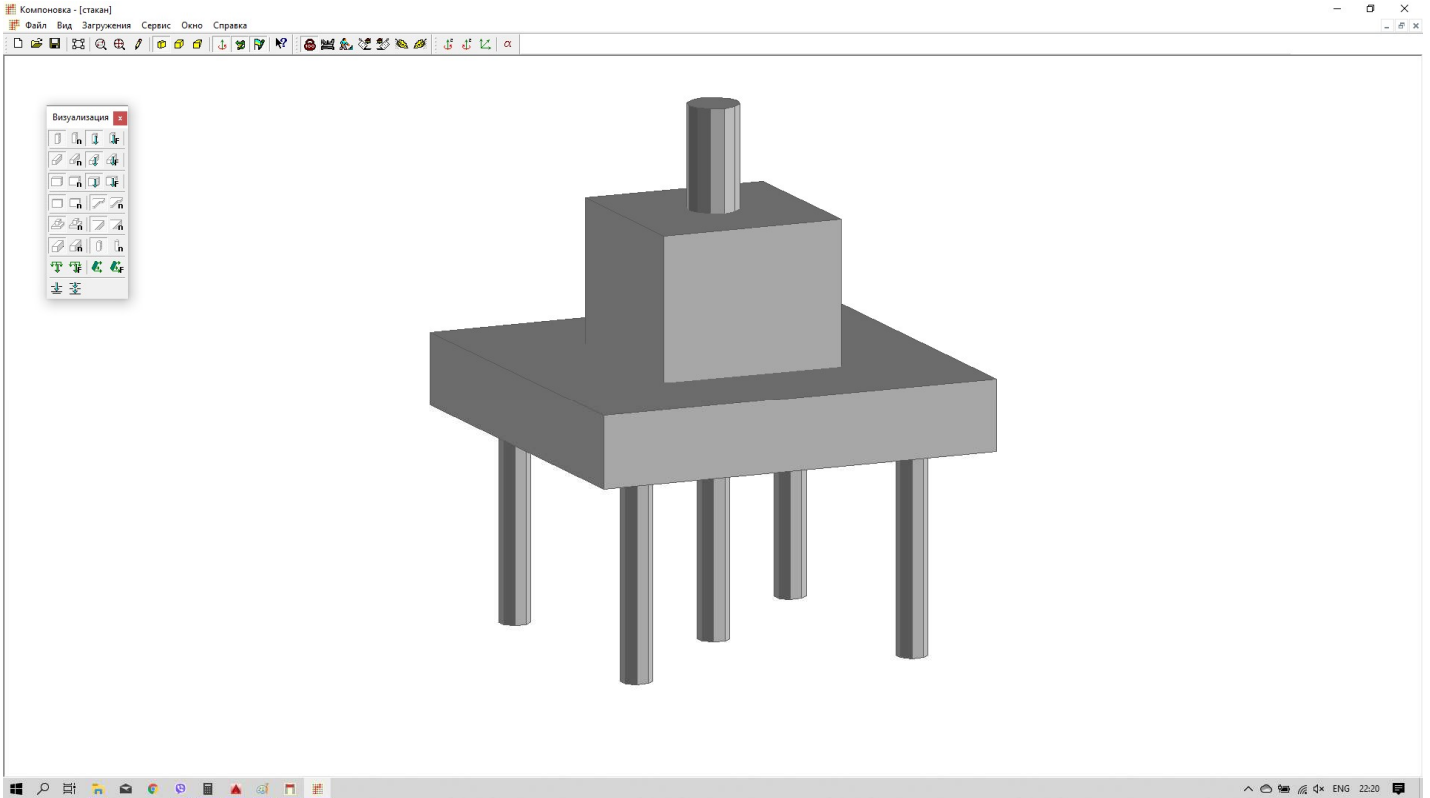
Розрахункова схема фундаменту на палях (варіант II)
